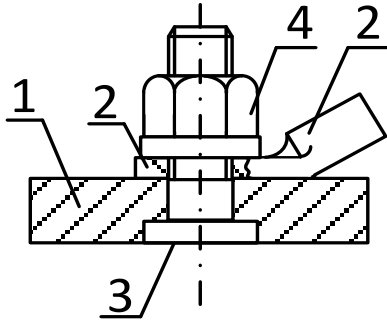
Контактное соединение шин ШУП-МСУ через винт запрессовочный для подключения кабеля от главной заземляющей шины или других токопроводящих конструкций (1 - медная шина; 2 – кабельный наконечник; 3 – винт запрессовочный; 4 – гайка с зубчатым фланцем).
